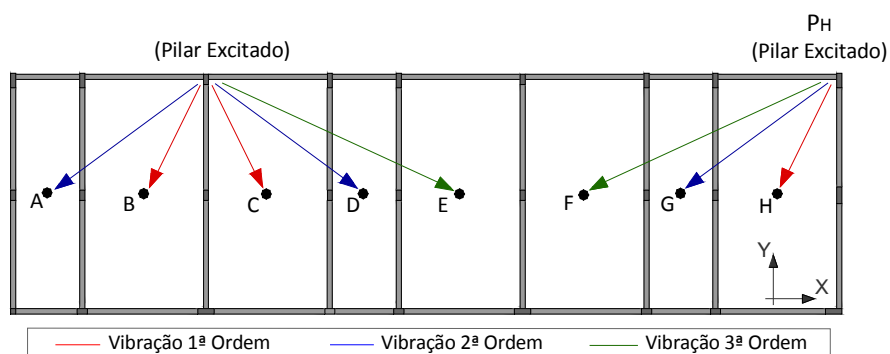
Vibração de 1ª ordem, de 2ª ordem e de 3ª ordem no pavimento do modelo completo 1, devido a forças de excitação nos pilares
